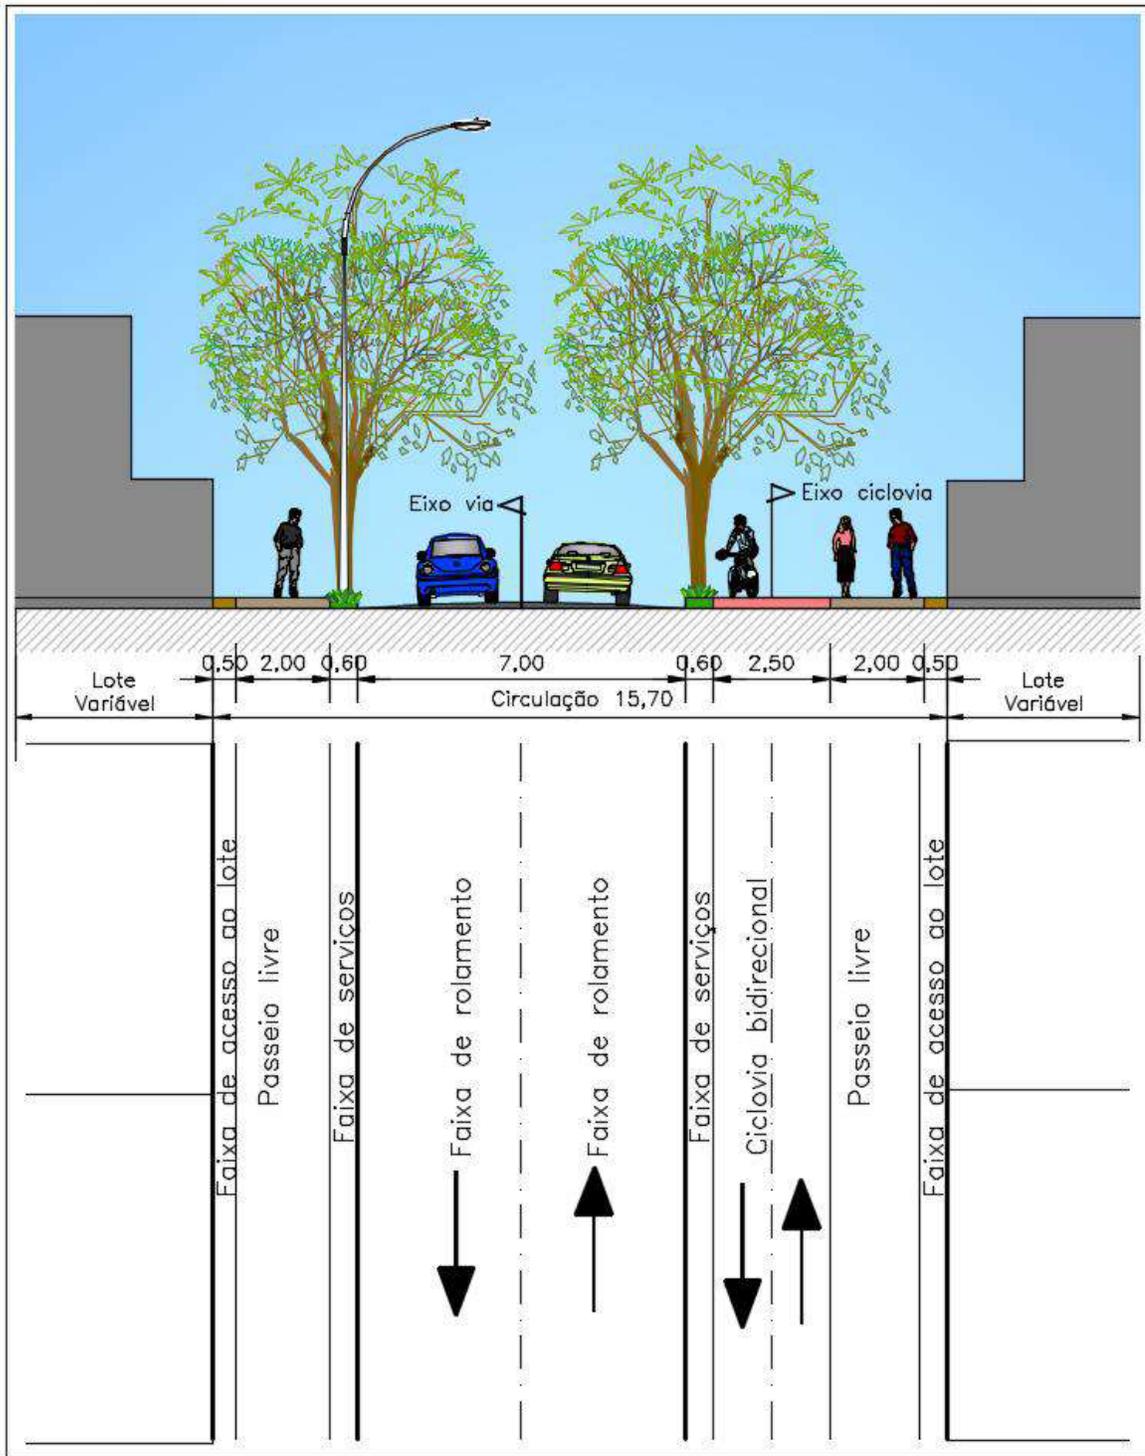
Perfil 4 – Via de circulação de vizinhança - tipo 02
